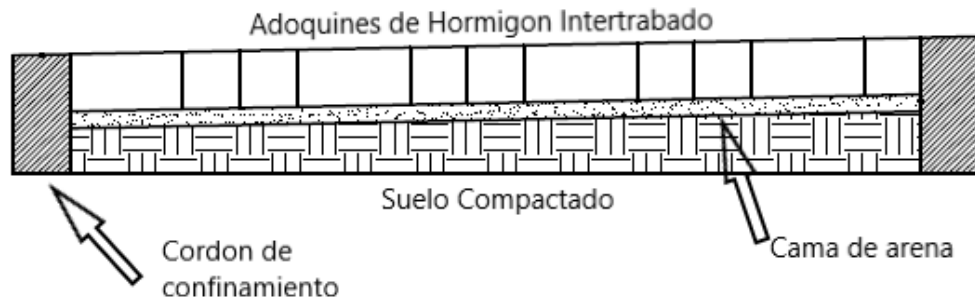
Perfil de paquete estructural de pavimento intertrabado.
